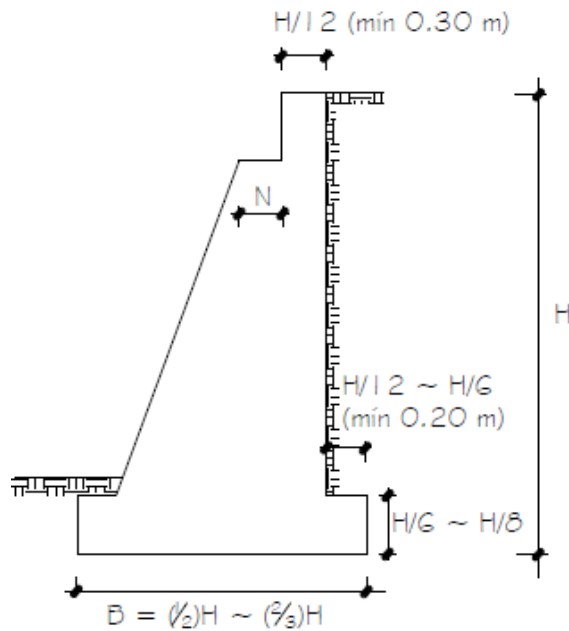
Predimensionamiento de estribos de gravedad (hormigón simple). Fuente: Rodríguez Serquén, 2016
